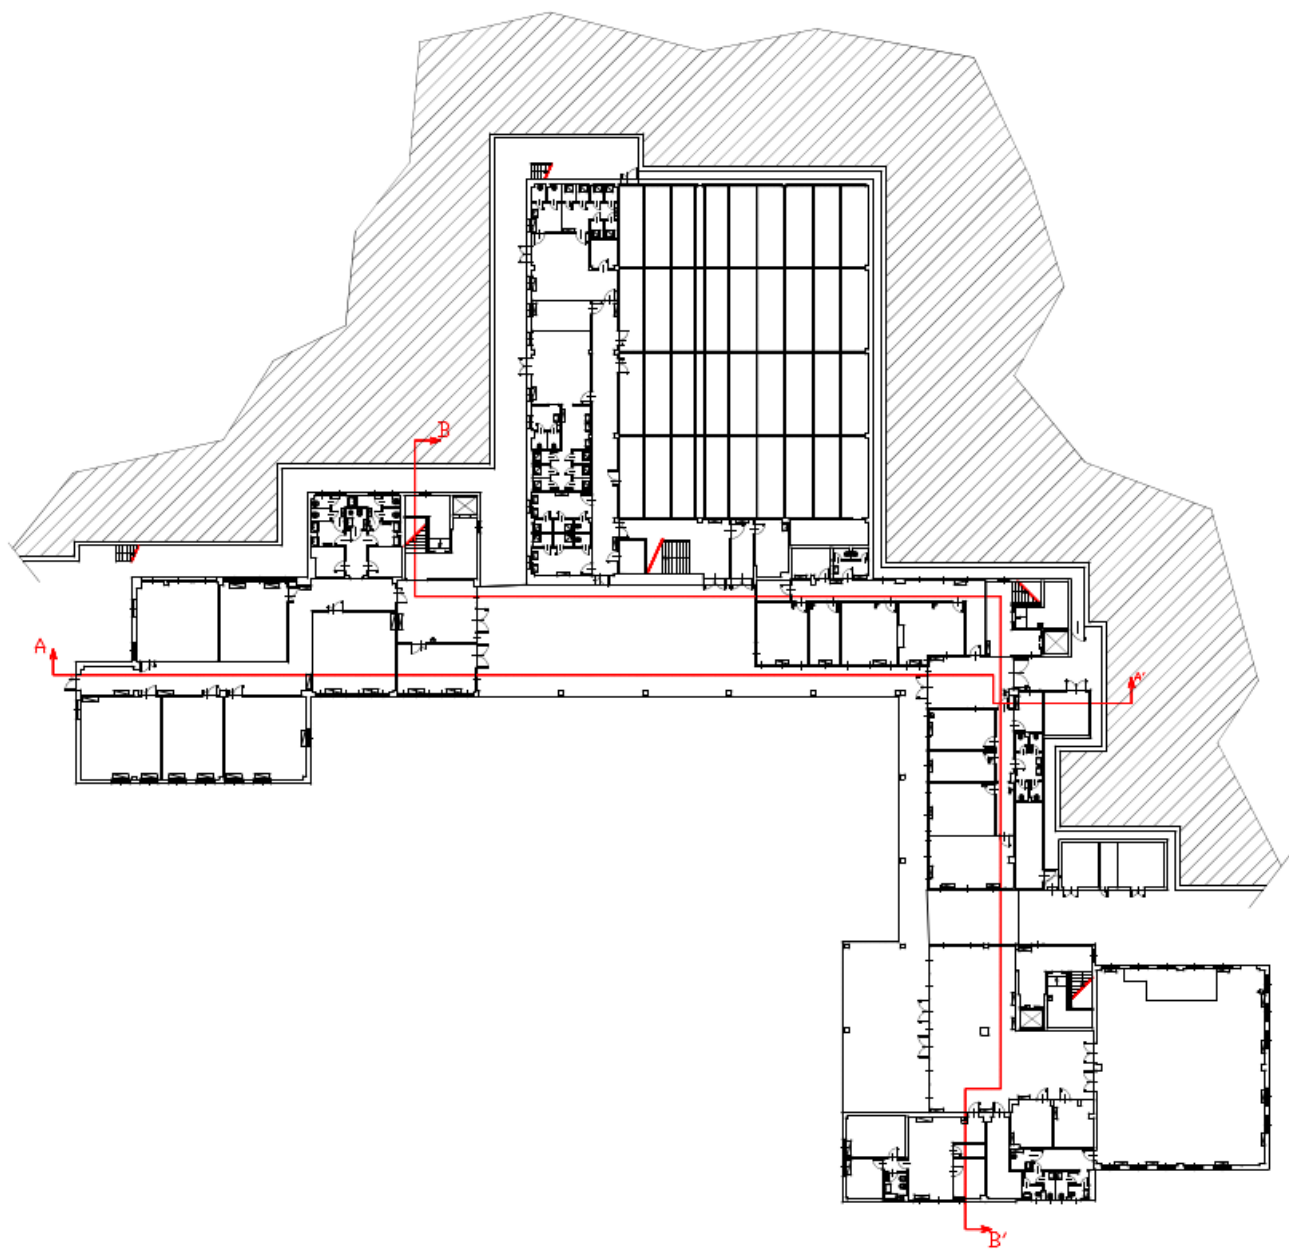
Pianta del piano terra e indicazione delle sezioni principali.
